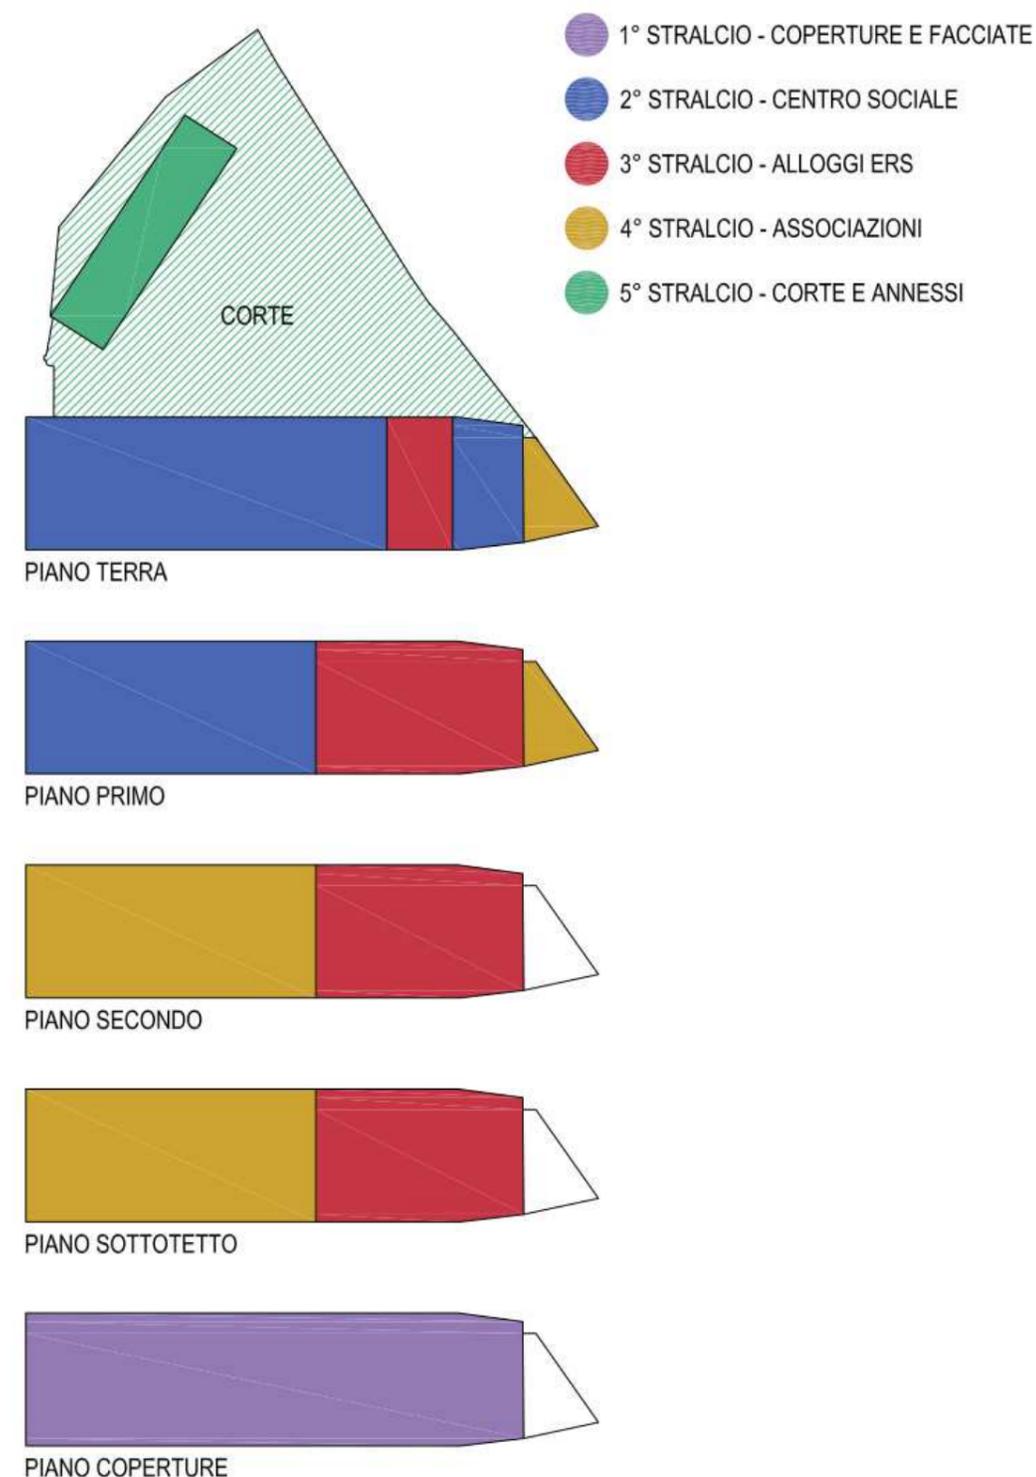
Schema esplicativo stralci funzionali intervento complessivo Palazzo Abbondanza
